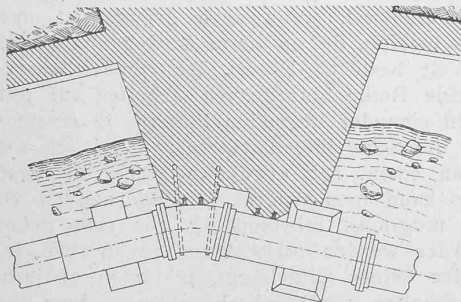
Hintermauerung (Grundriss). 1 : 100.
